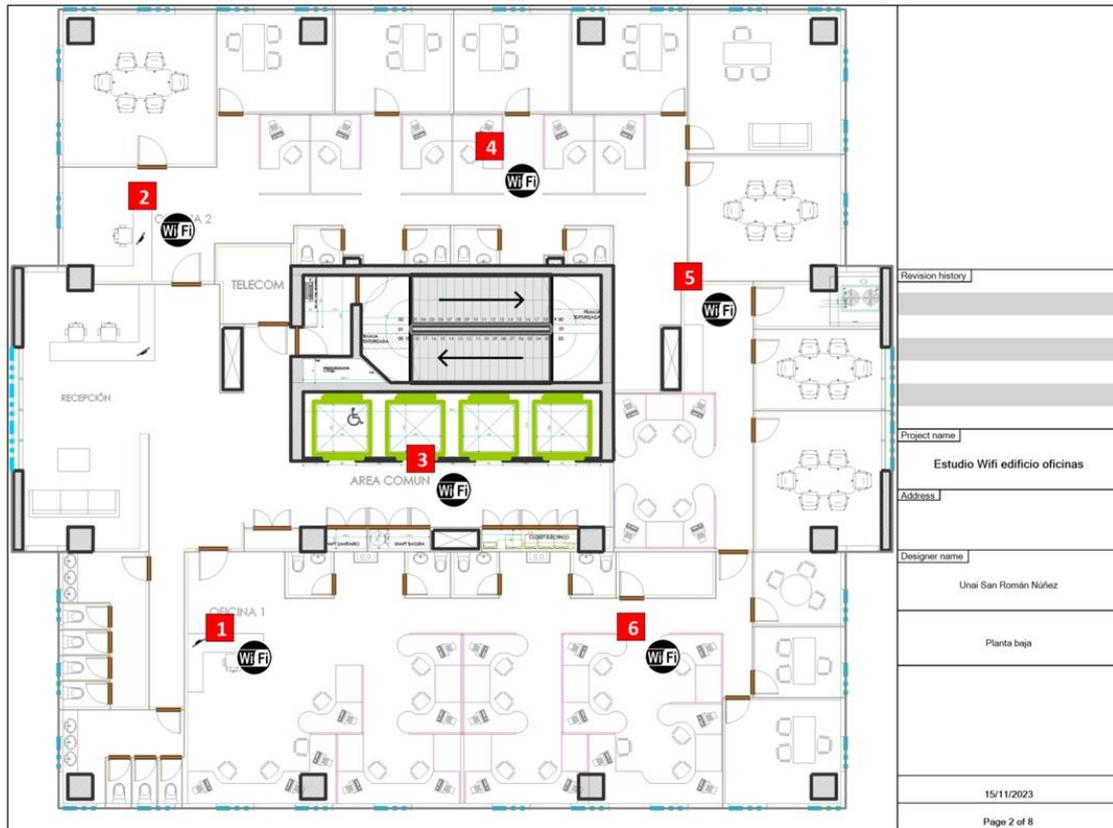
Posicionamiento Puntos de Acceso. Planta baja.
